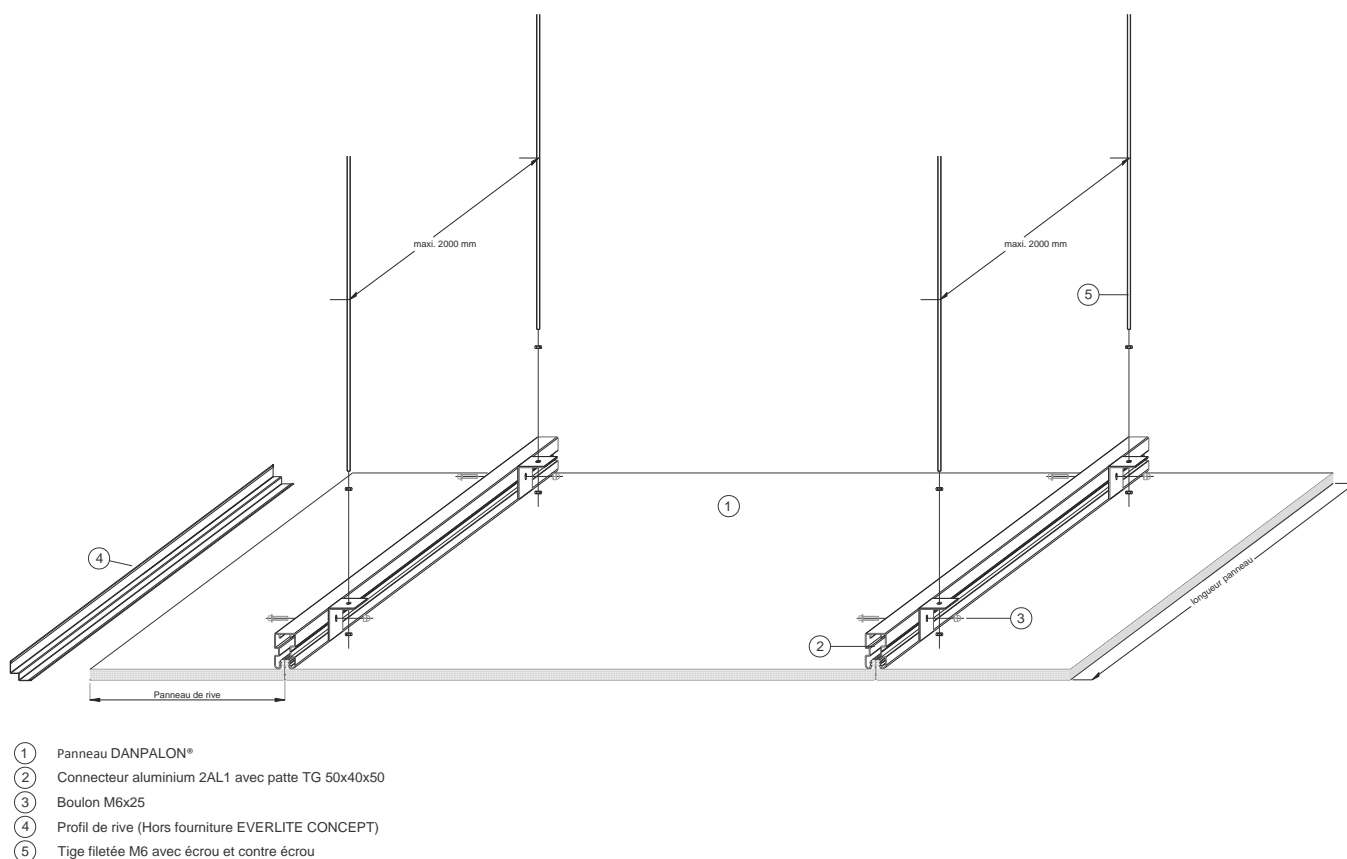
Connecteur 2AL1 – système DANPALON® application plafond suspendue
